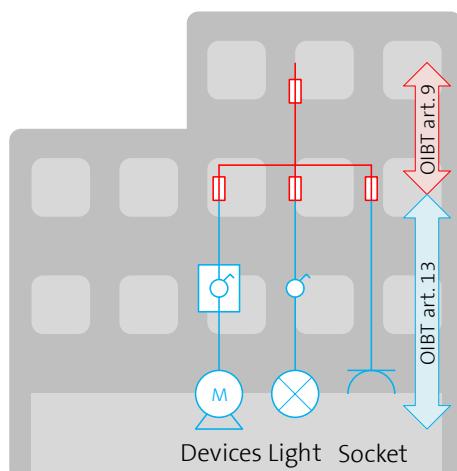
Campo di applicazione dell'autorizzazione, Art. 13 OIBT
